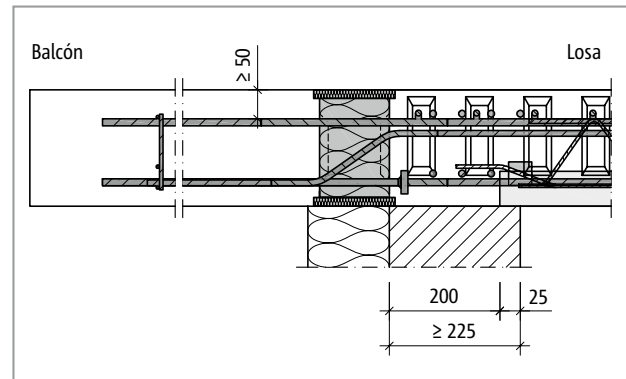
Schöck Isokorb® XT tipo C: Placa prefabricada sin apoyo periférico con SATE (sección XT tipo C-R-CV50, vista XT tipo C-L-CV35)
